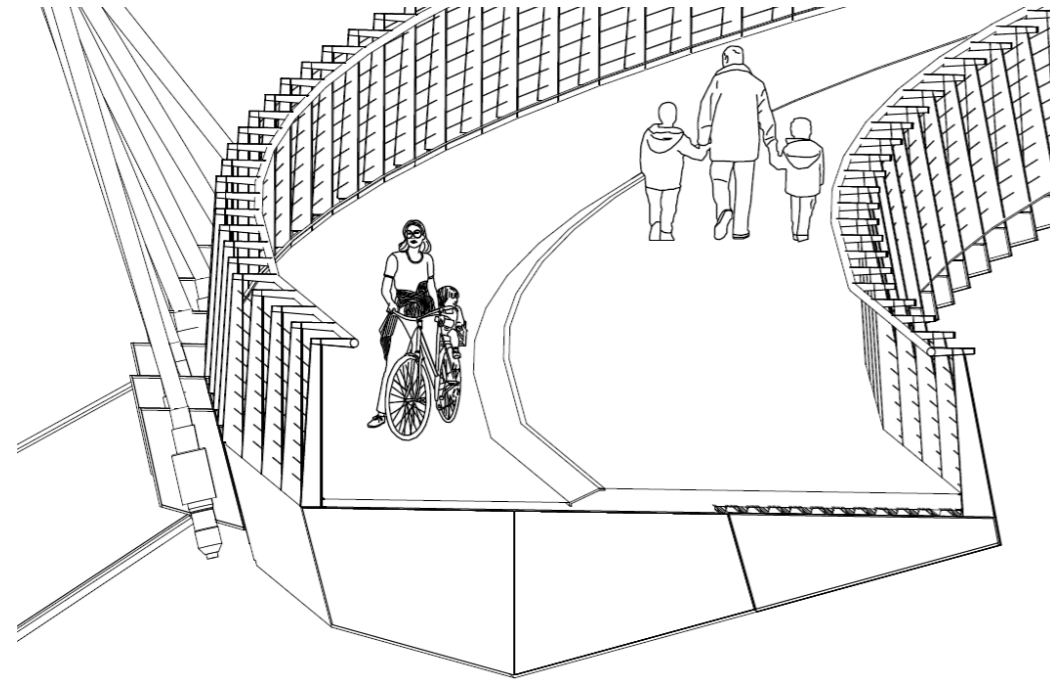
Vista 3D de la pasarela en servicio con secciones de atirantamiento. Fuente: Elaboración Propia (AutoCAD)
